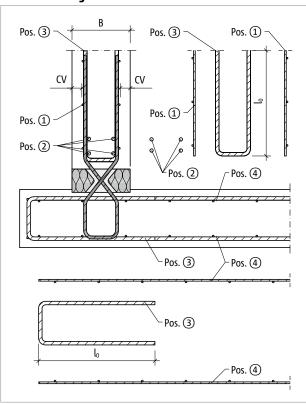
Schöck Sconnex® type W-N-VH : variante B - renforcement sur site pour le raccordement en pied de mur
